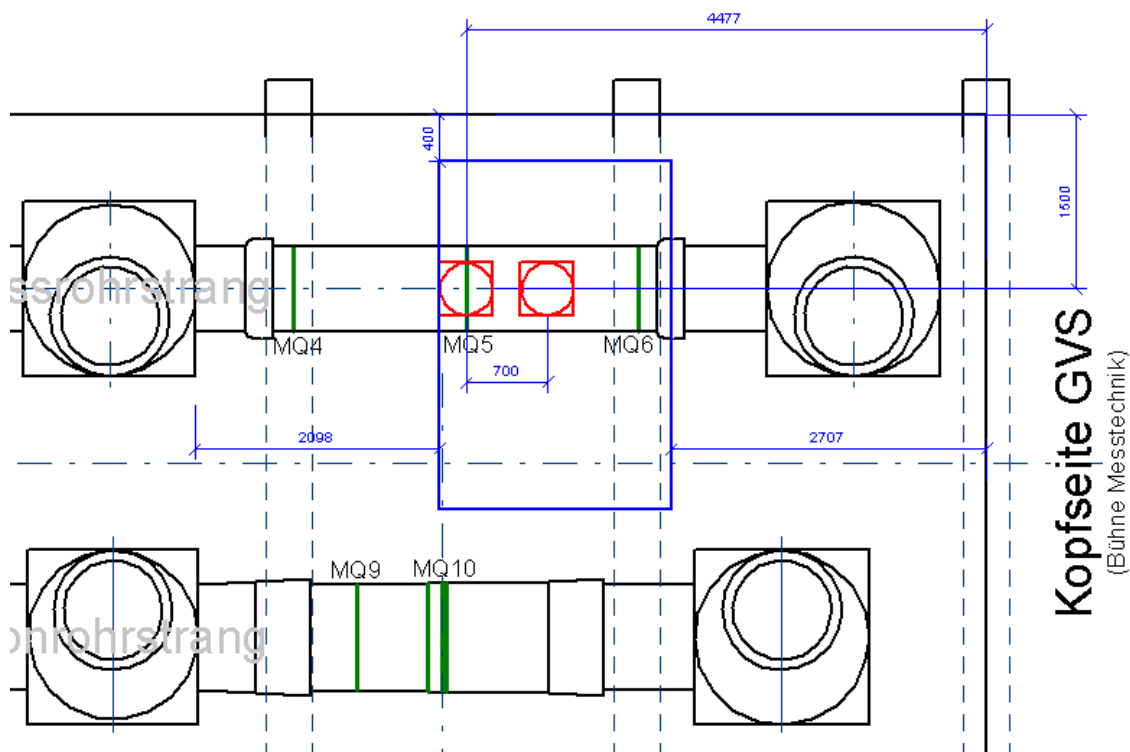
Positionierung der Hydraulikzylinder für den Lastfall „Radgruppe statisch - Kantenpressung“ auf der Lastplattenseite über dem Guss-Rohrstrang
